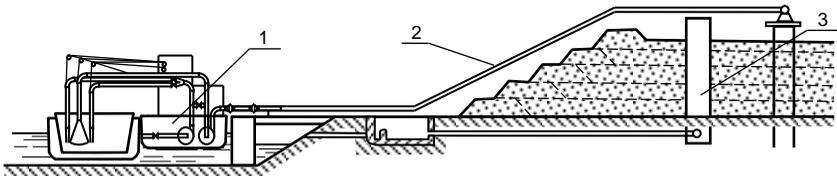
Схема механизации выгрузки песка гидроперегрузателем:
